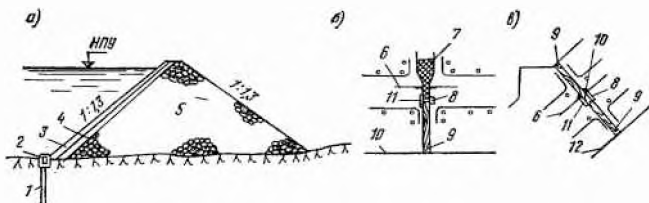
Плотина Парадела с полужестким железобетонным экраном
